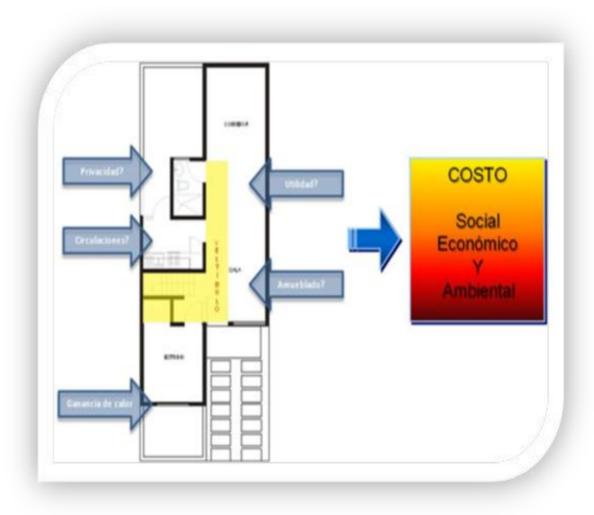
Planta arquitectónica baja de la vivienda tipo de la primera etapa del fraccionamiento San Fernando
